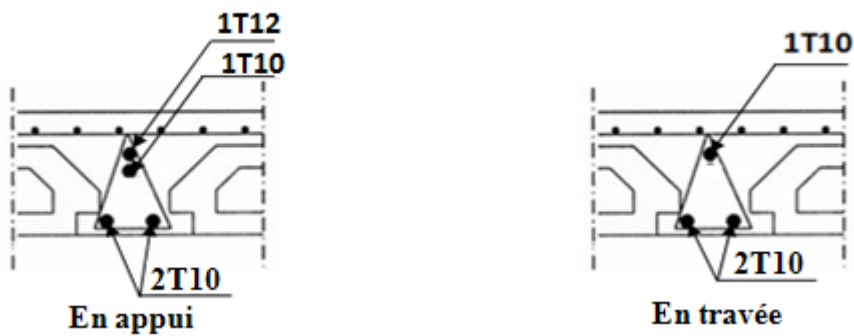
disposition des armatures dans la poutrelle (appuis et travée)
